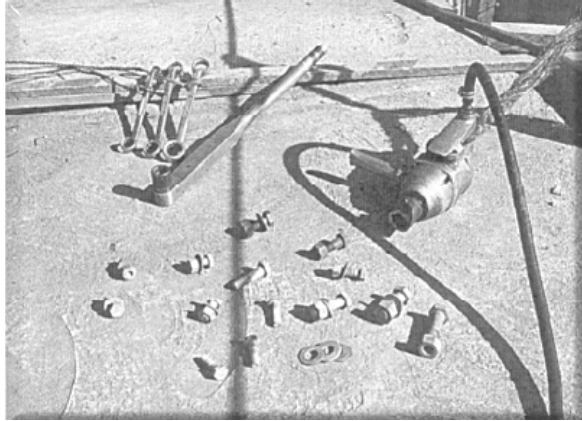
Equipamentos usados para ligações parafusadas.
